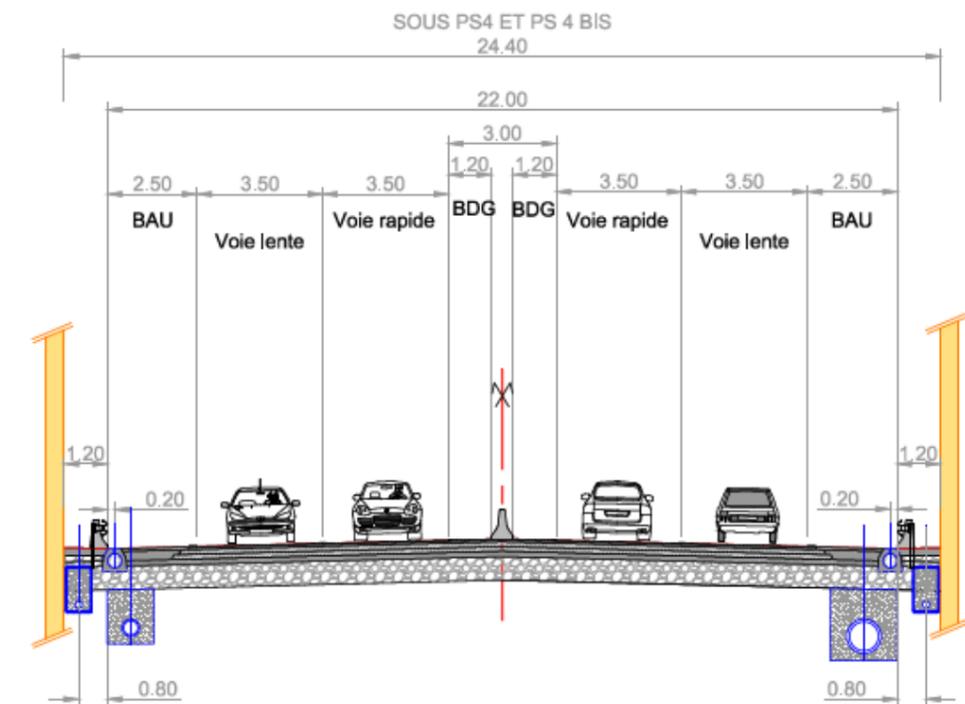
Profil en travers type de la section courante en configuration déblais – chaussée neuve sous giratoire dénivelé
